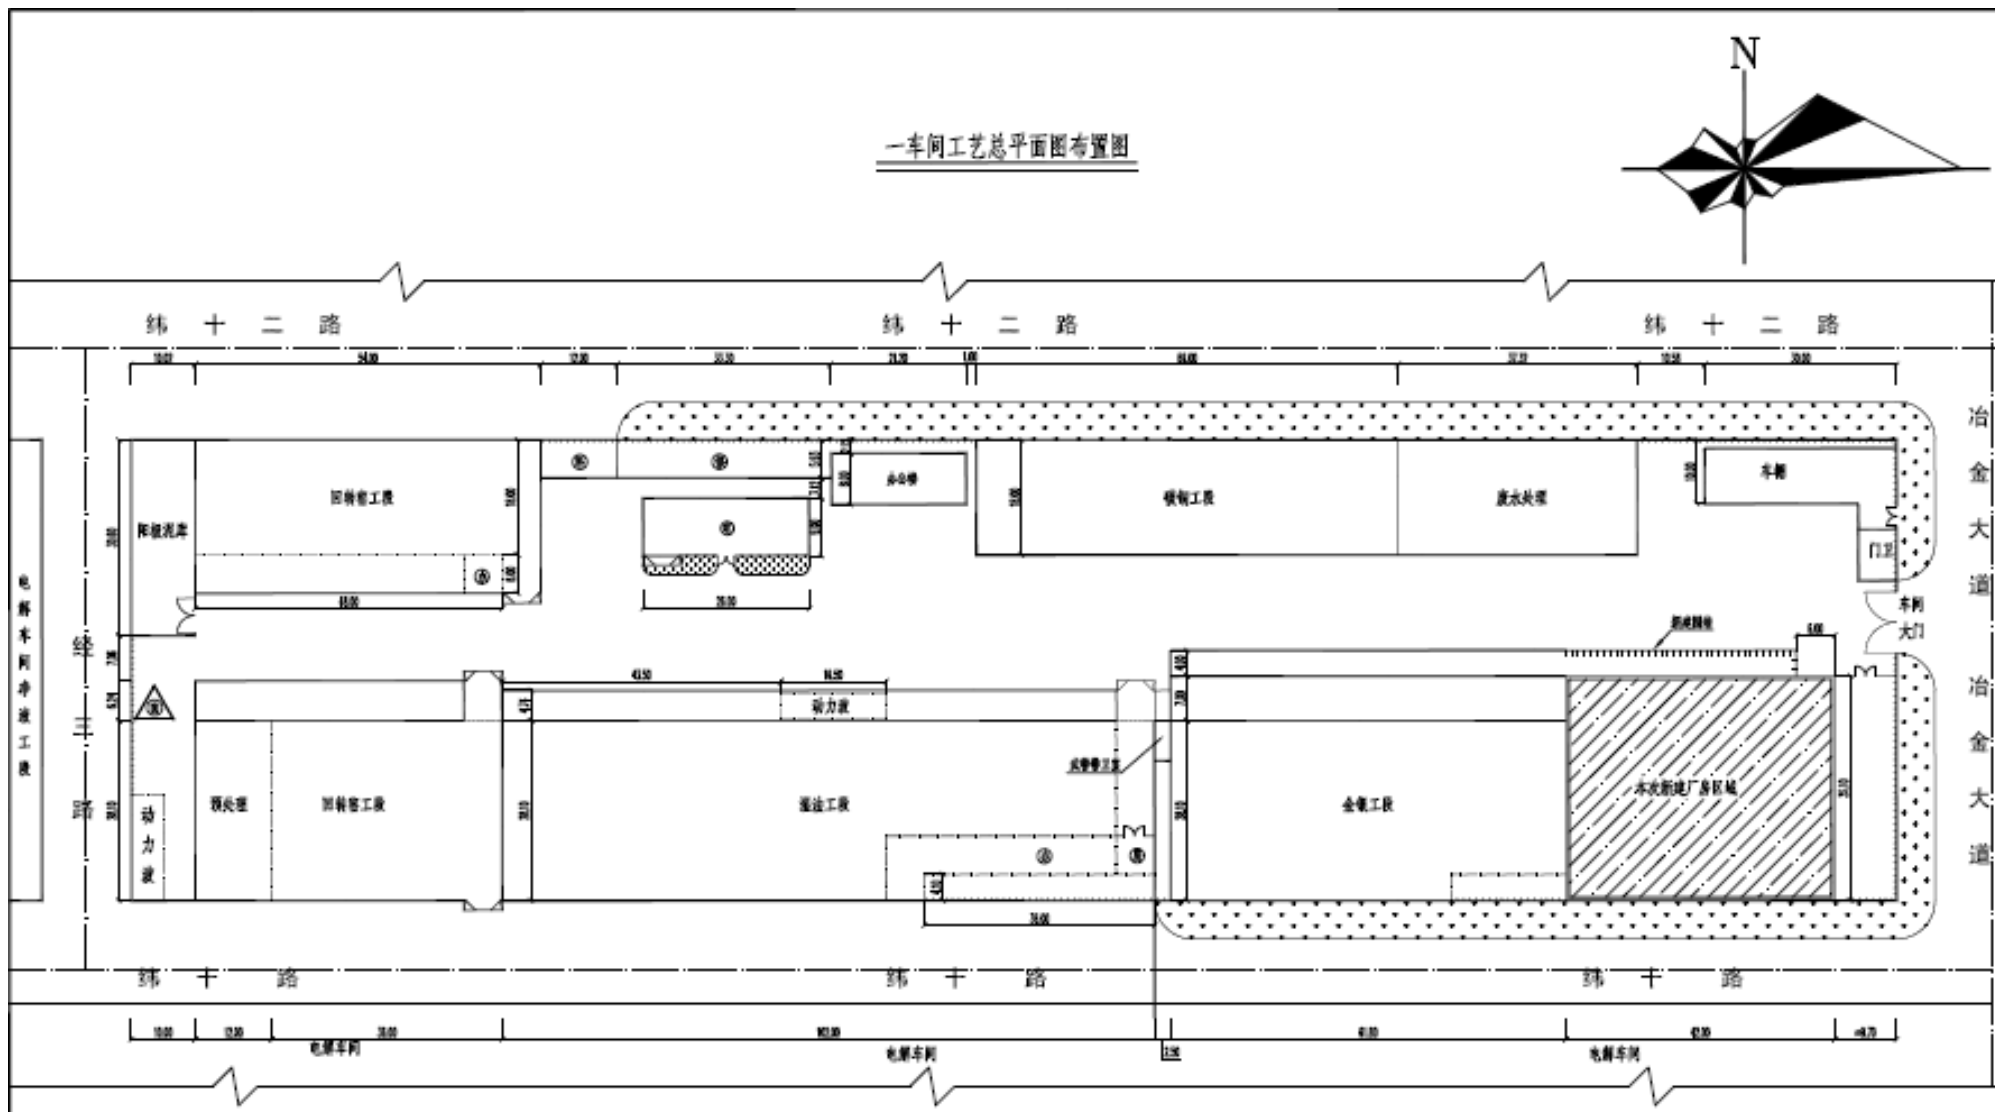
贵溪冶炼厂一车间生产线车间平面布置图
